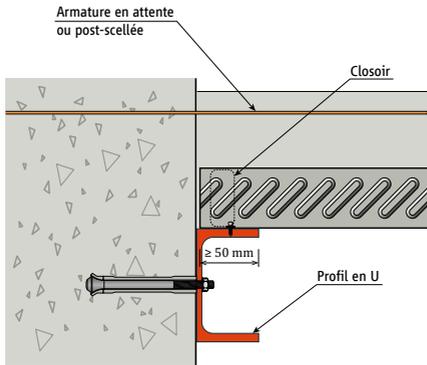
Liaison d'une dalle mixte sur un voile en béton armé – Cas de nervures perpendiculaires au voile
